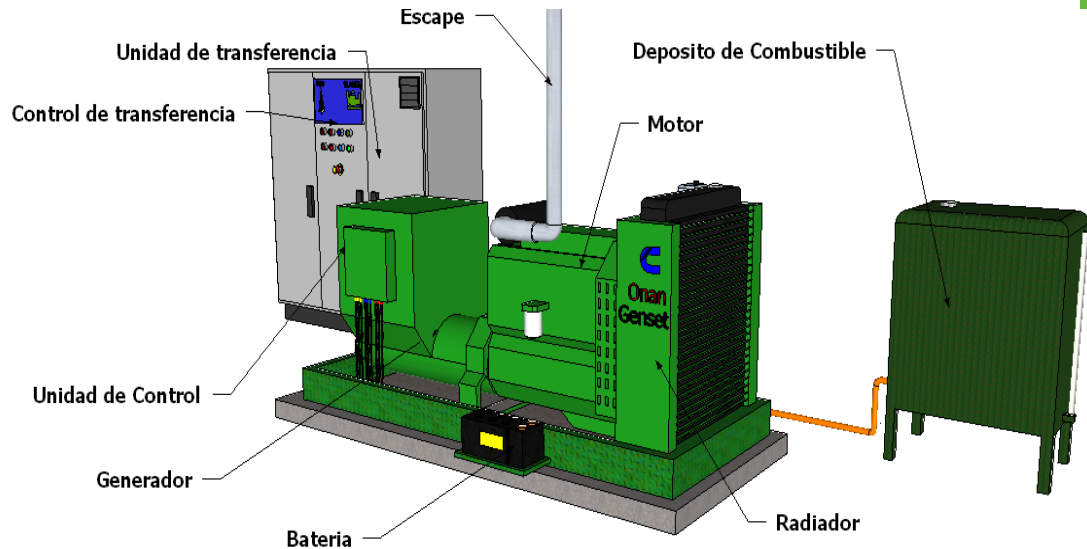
Elementos básicos de una planta eléctrica de emergencia
